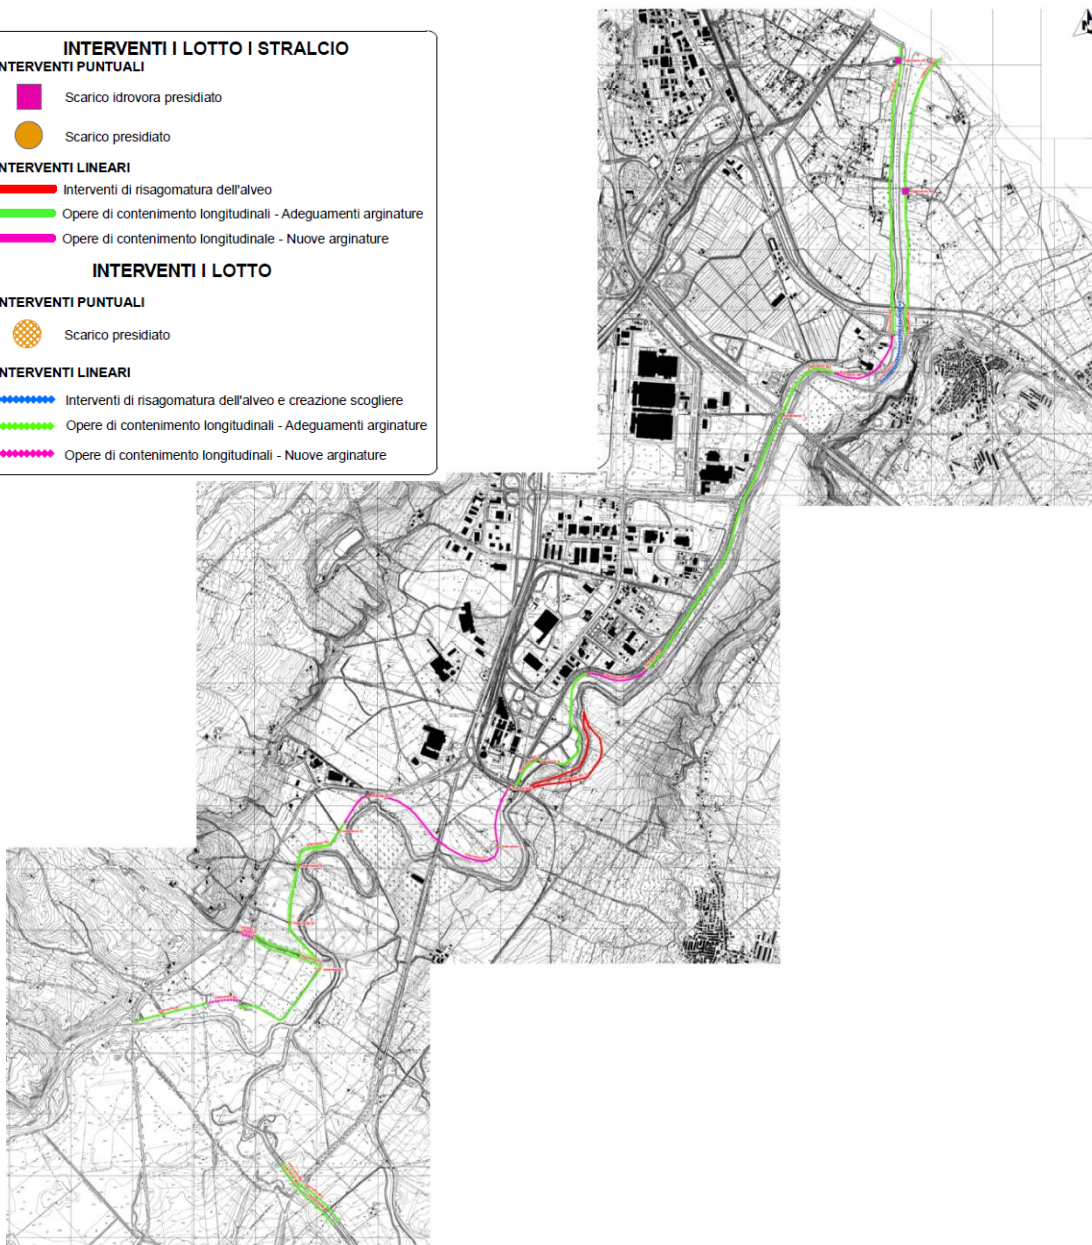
Configurazione Post operam AdB (fonte: Planimetria con ubicazione interventi di progetto – Tavole D.2).
